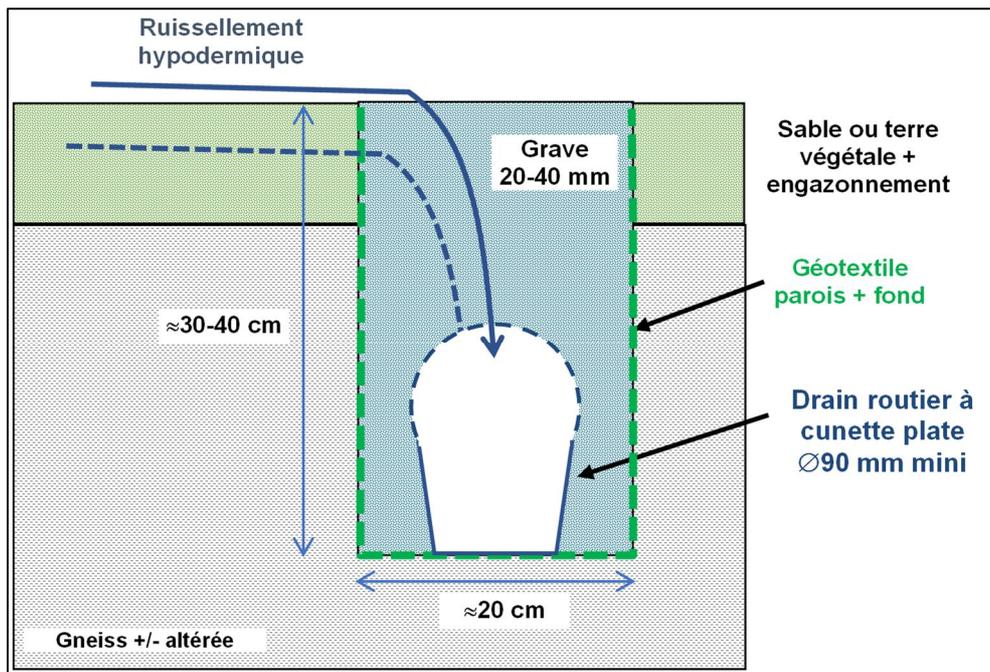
Coupe de principe d'une tranchée drainante peu profonde
